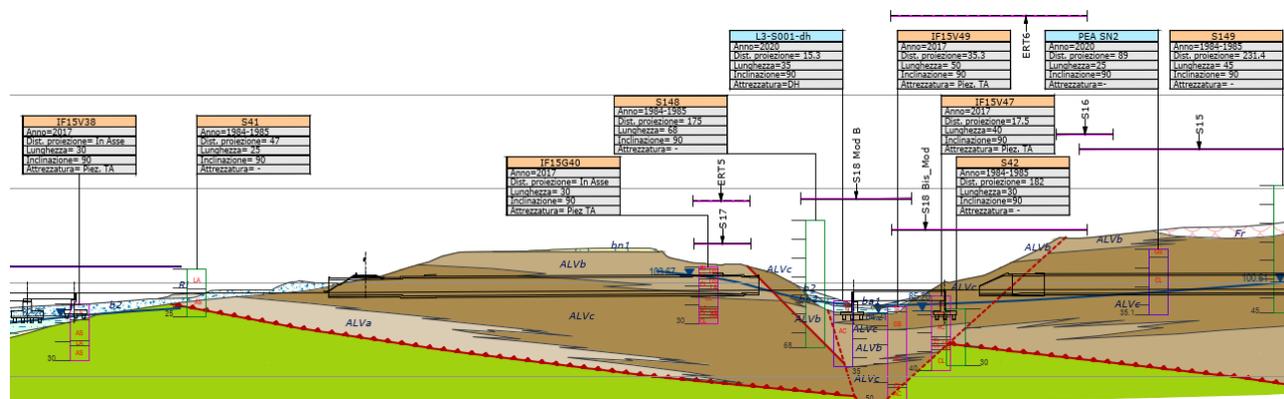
Sezione geologica dei versanti interessati dalla realizzazione della galleria Reventa e della galleria Le Forche.
